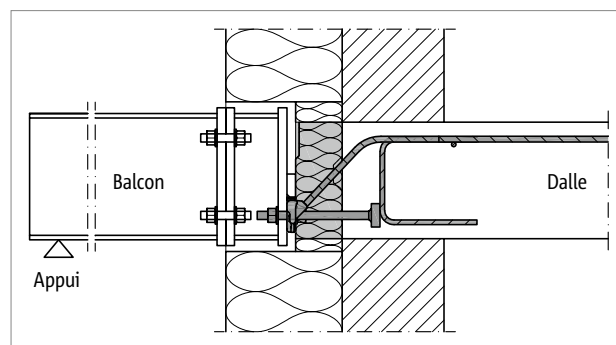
Schöck Isokorb® T type SQ : raccordement de la poutre en acier à un adaptateur permettant de compenser l'épaisseur de l'isolation thermique extérieure
